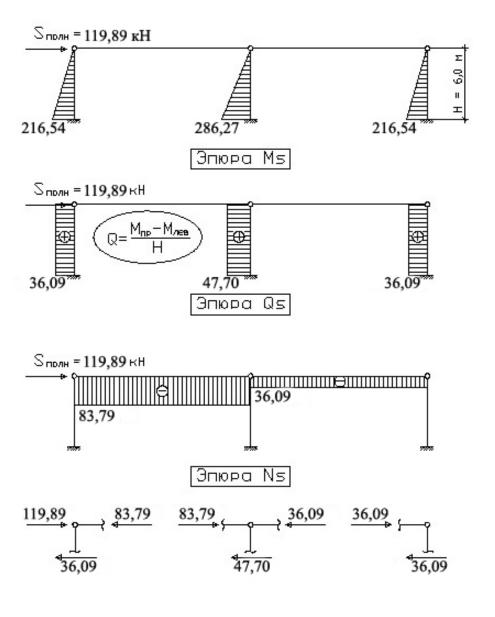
Эпюры усилий в поперечной раме по оси 2 от действия сейсмической силы.
